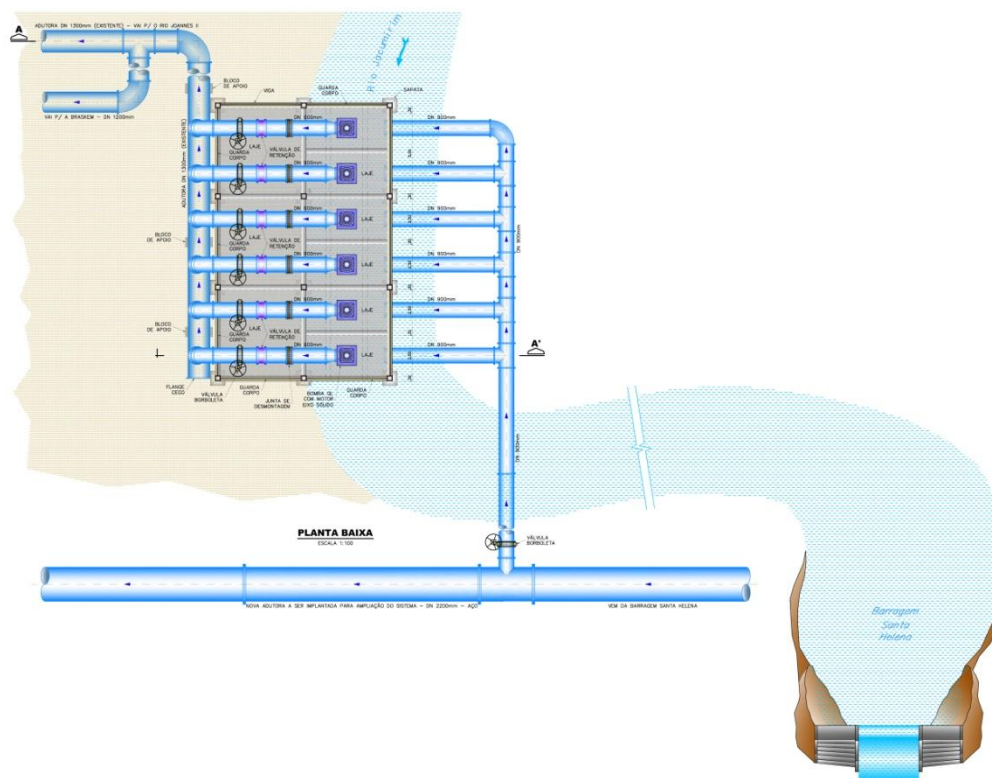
Planta baixa da Estação Elevatória existente com adaptações para conexão da nova adutora e ramais de alimentação do poço de sucção
